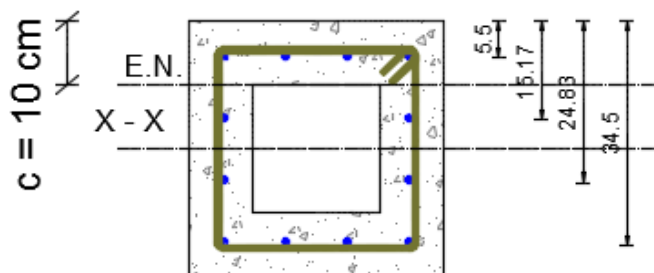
Esquema de deformaciones en la sección transversal cuadrada
